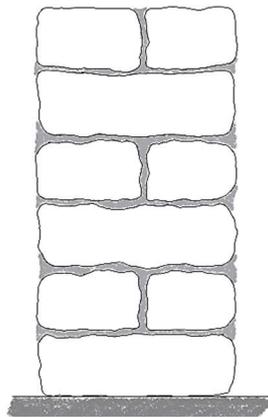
Muro de gravedad. (Fuente propia, basado en [4])
